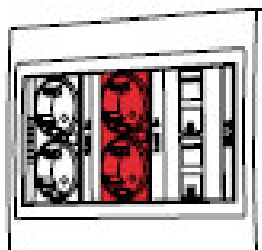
Modelo de caja TIPO A propuesta en proyecto para aulas de primaria.
